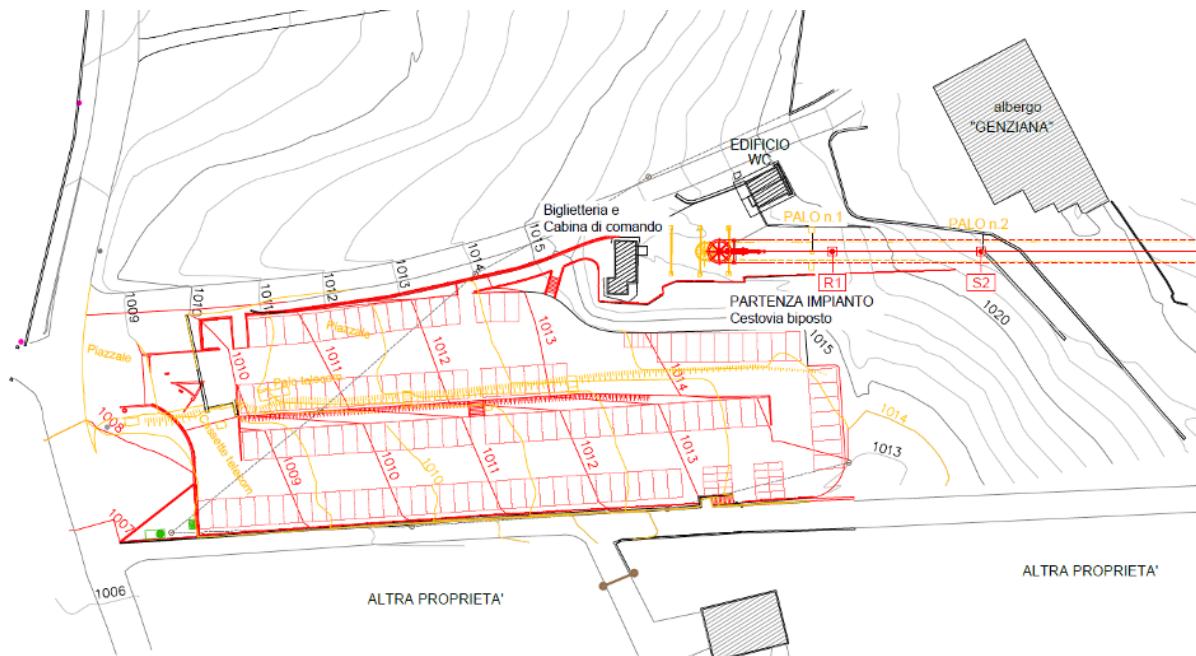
stazione motrice a valle (stato di raffronto con impianto esistente - progetto ProAlpe).
